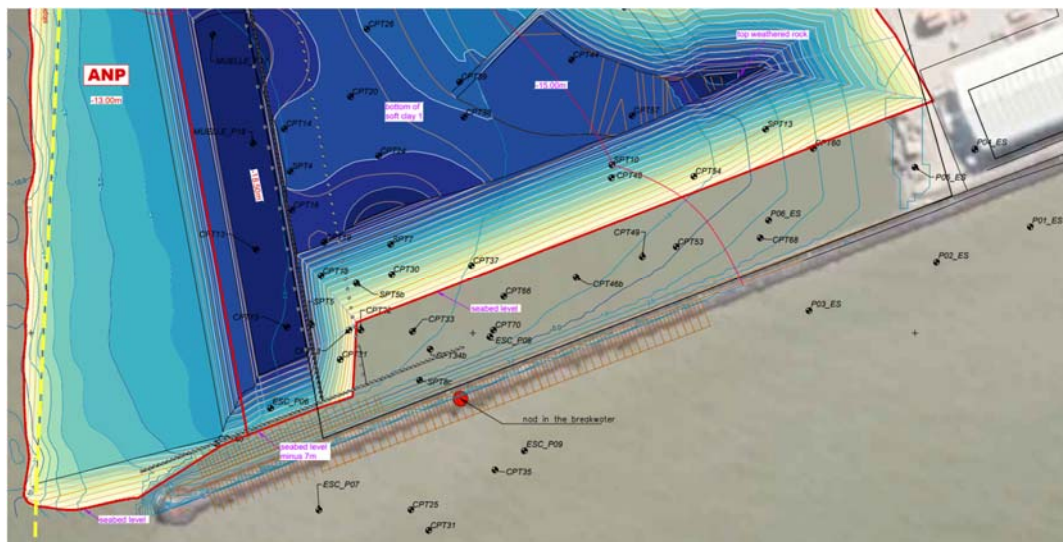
Fosa de dragado, combi-wall de protección para la escollera, y taludes de la fosa de dragado. El límite de la zona de dragado se indica con línea roja continua.
